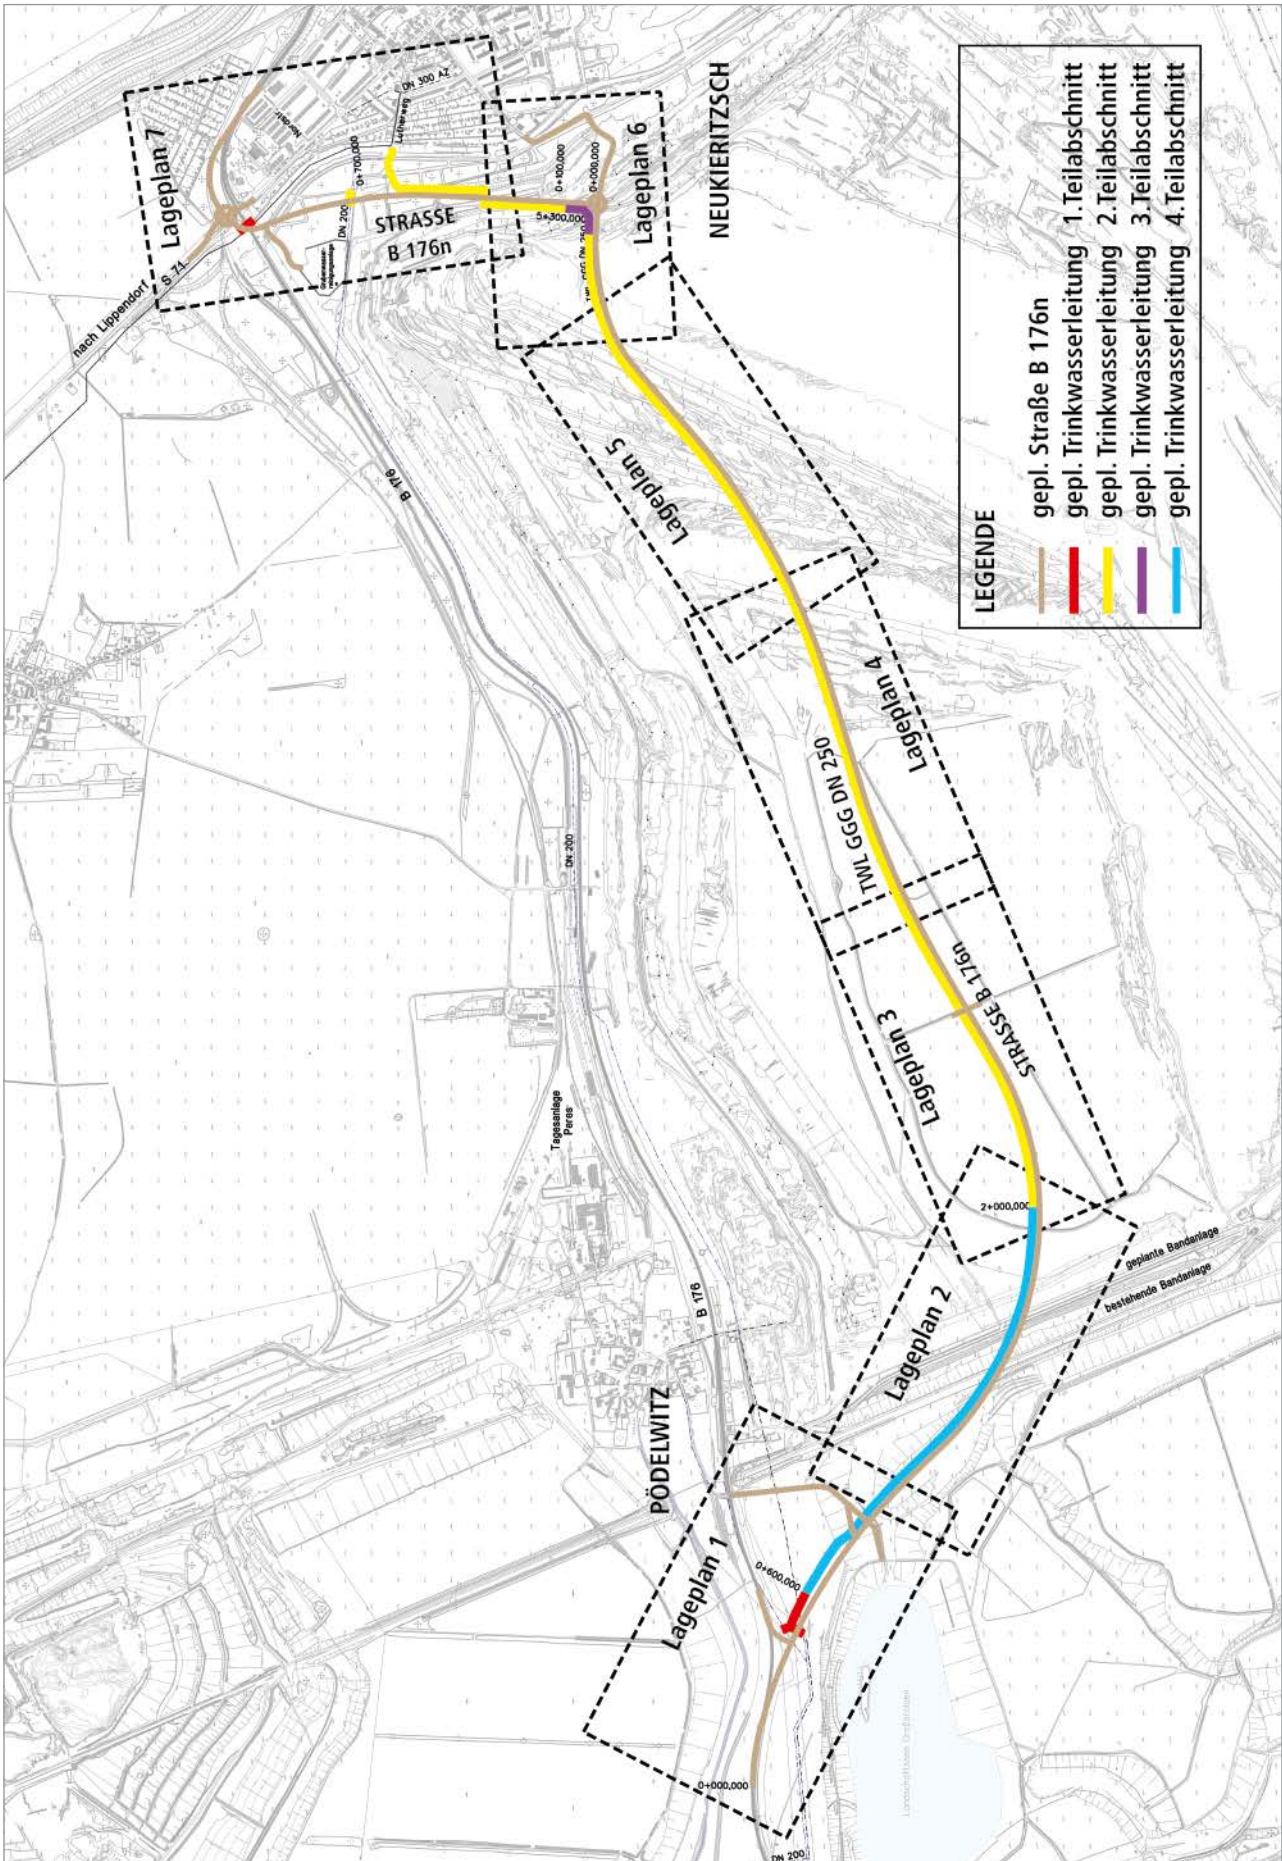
Lageplan mit den einzelnen Rohrleitungsbauelementen zwischen Pödelwitz und Neukieritzsch
